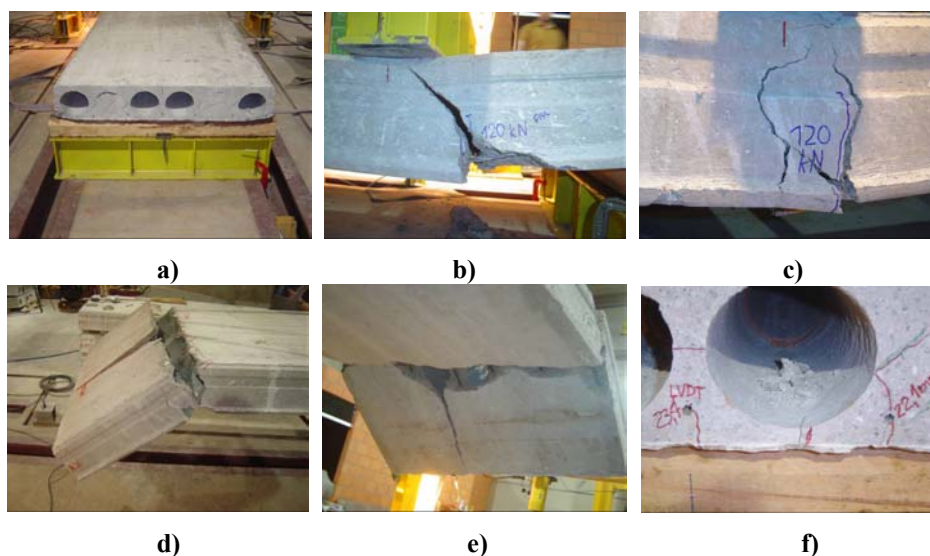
Configuração de fissuração da laje L08-SC-AP-7_C: a) Laje com dois alvéolos preenchidos; b) Fissuração da lateral da laje (lado esquerdo); c) Fissuração da lateral da laje (lado direito); d) e e) Laje após sua ruptura; f) Detalhe da fissuração ao redor das cordoalhas de protensão.
